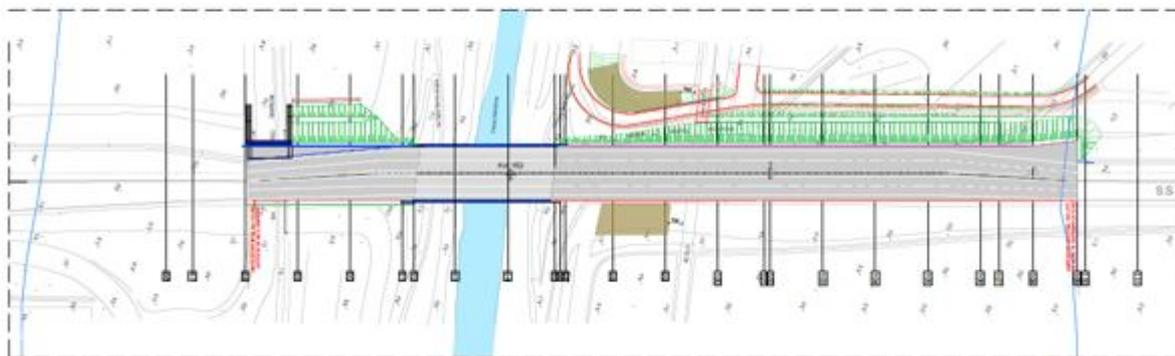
Planimetria degli interventi mitigativi - TRATTO A (T02IA00AMBPP01\_B)
